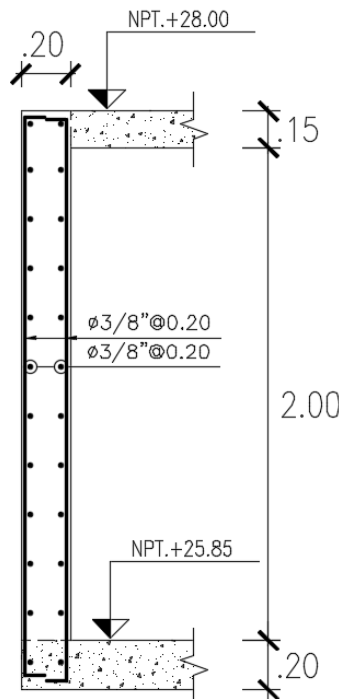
Disposición final de acero en la pared del tanque elevado.
